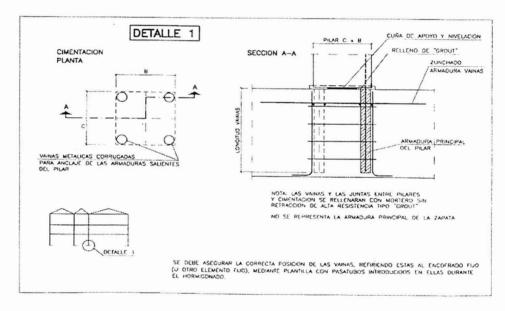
Nudo -"cimentación-pilar prefabricado".
